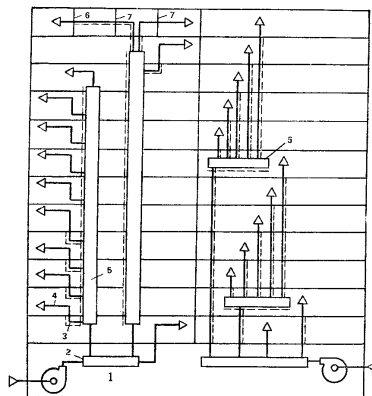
Схема систем вентиляции для многоэтажных зданий:
